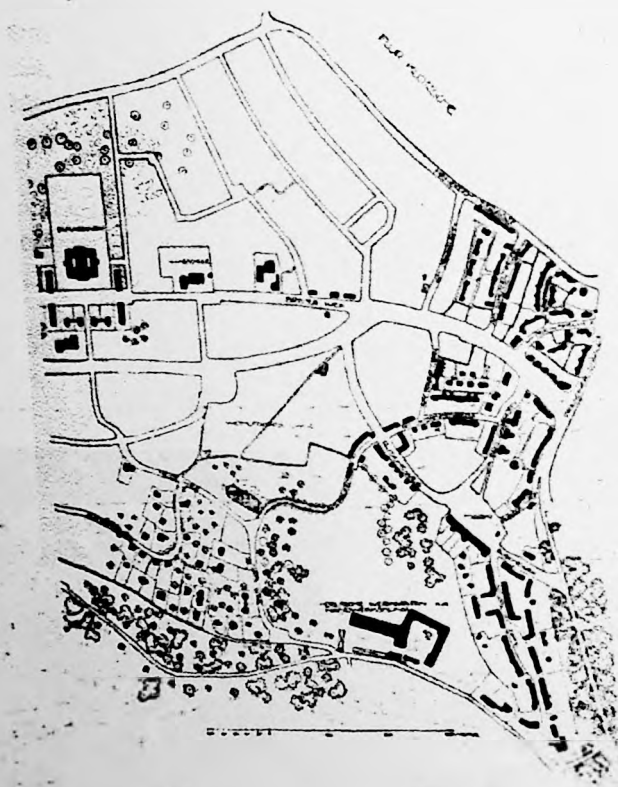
Lageplan der Gartenstadt Hellerau (Siedlungsplan).
